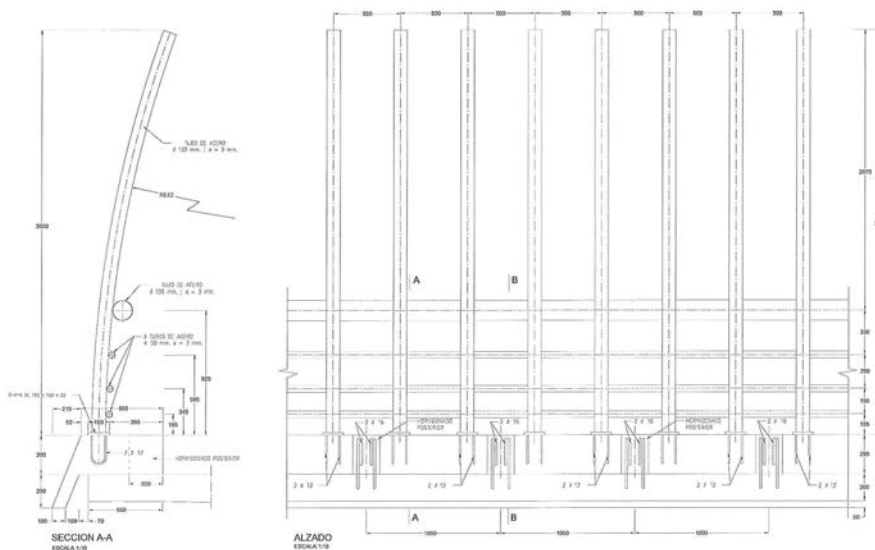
Plano de la pantalla anticolidión diseñada para el futuro viaducto sobre el río Tajo de la LAV Madrid – Extremadura. Tramo: Talayuela – Cáceres. Fuente: Proyecto de Construcción de Plataforma de la Línea Madrid – Extremadura. Tramo: Cañaveral - Embalse de Alcántara
